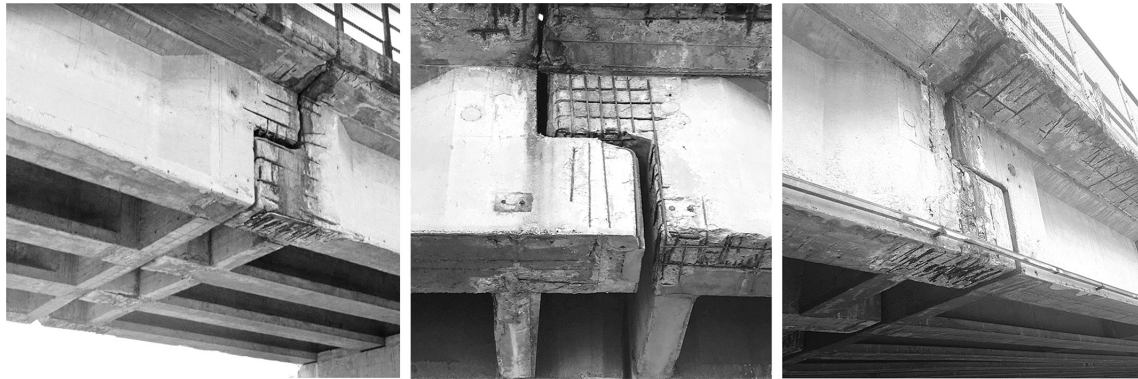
Poutre Gerber d'un pont se détériorant [2]
